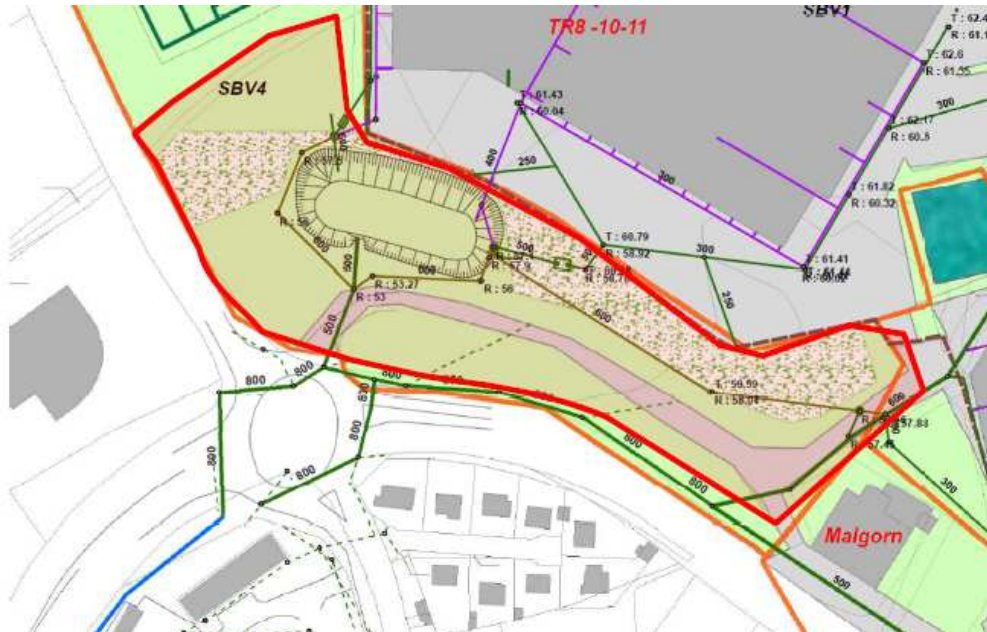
extrait des plans de réseau pluvial (source : cabinet BOURGOIS)
